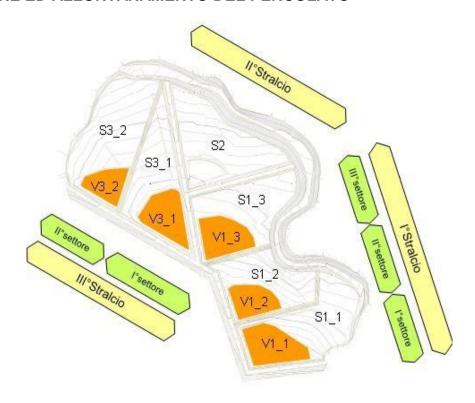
Schema planimetrico degli stralci e dei settori di conferimento di Scarpino 3¹
